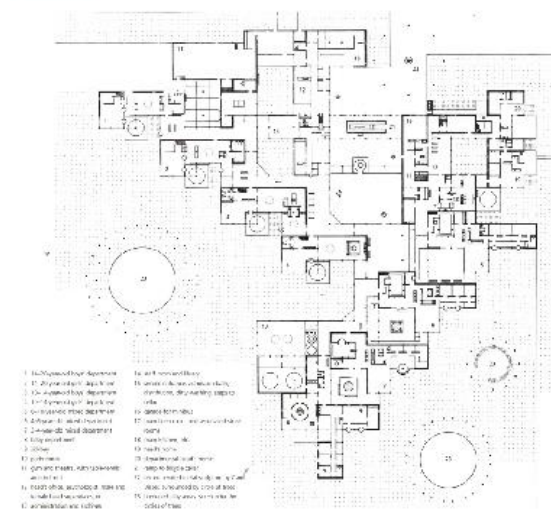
Planta 1. Dibujo de Aldo Van Eyck
